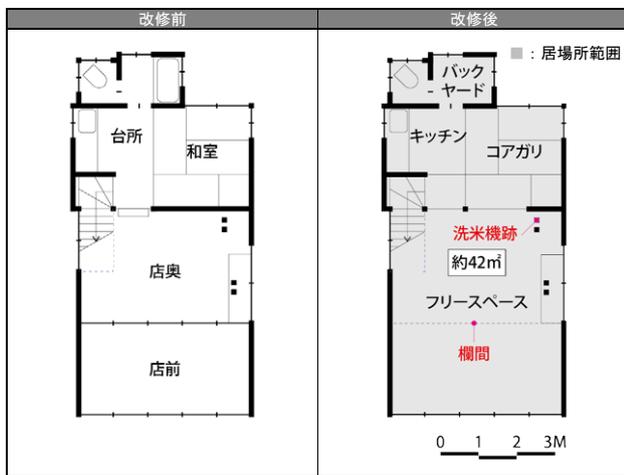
「こびなたぼっこ」改修前後の1階平面図 [筆者作成]
